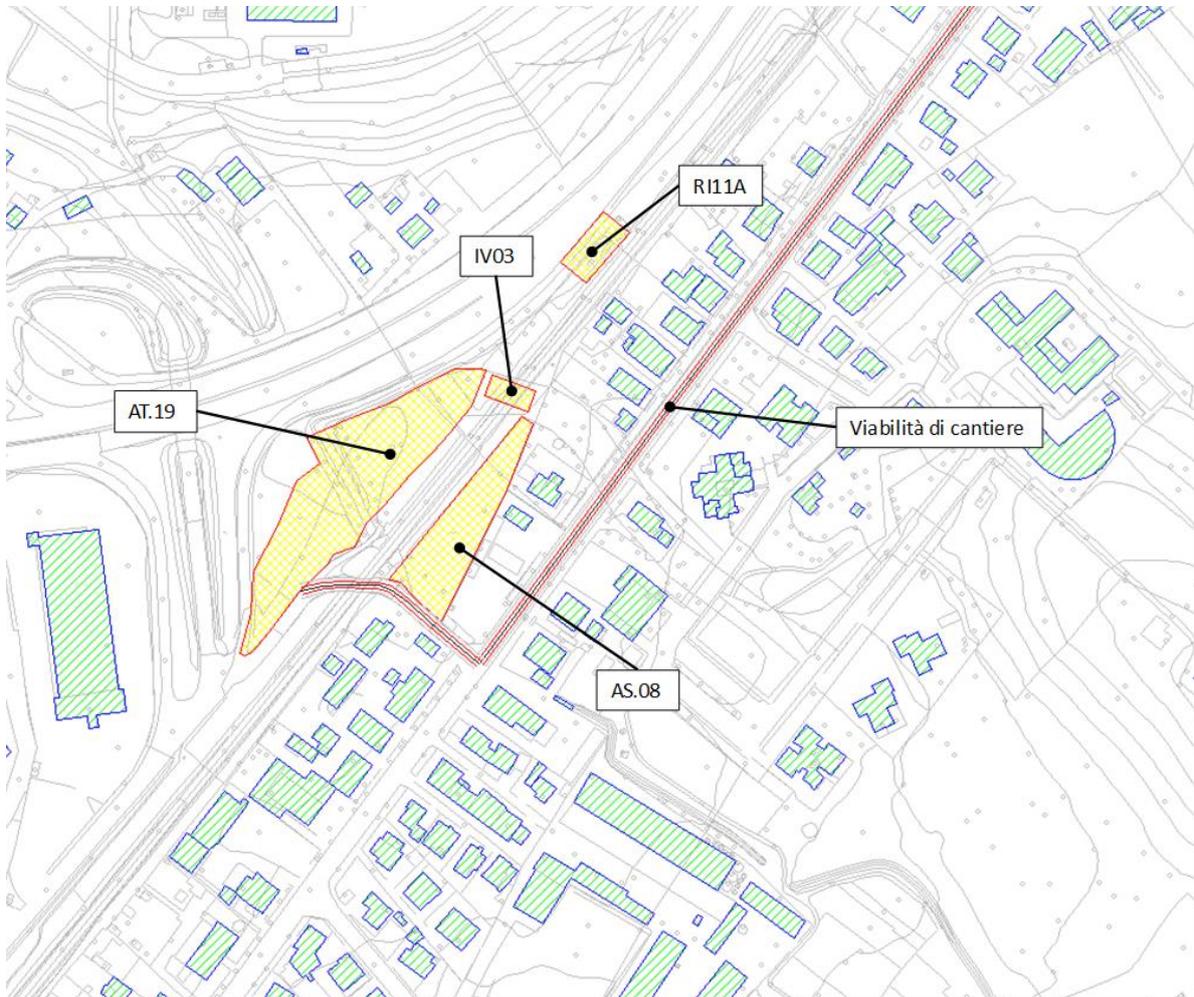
Scenario di simulazione 02 – Chieti Scalo: Planimetria in SoundPlan dello scenario oggetto di simulazione
